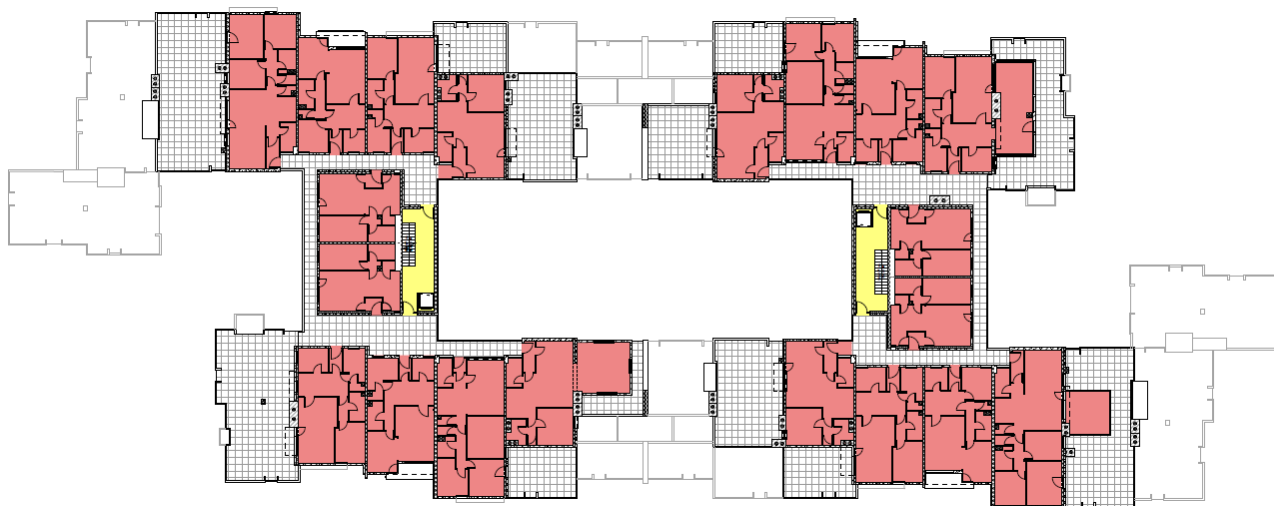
Projektna dokumentacija – shema zona – 1. kat
